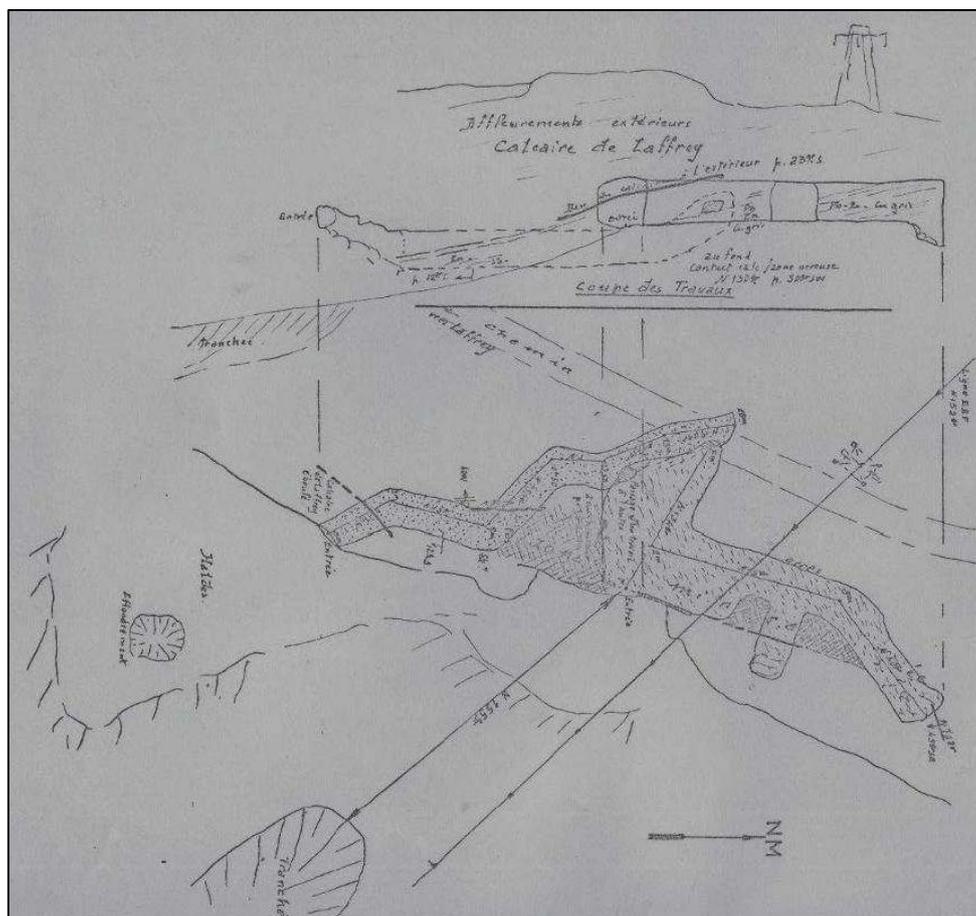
Plan et coupe des travaux de la concession de Péreire – Site Péreire (1966)
